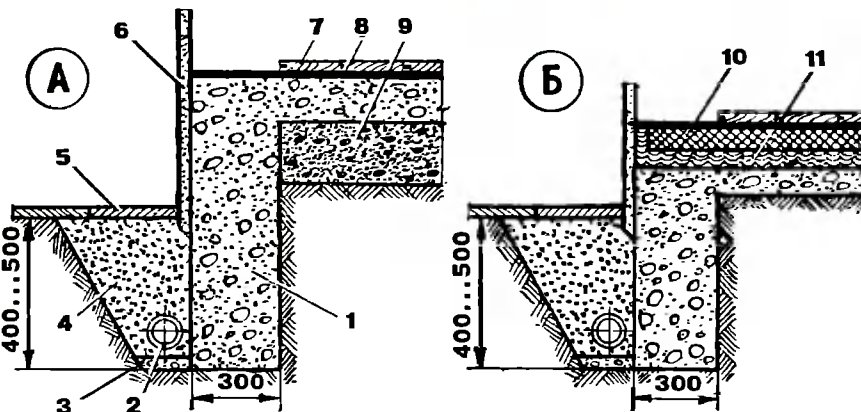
Фундамент (А — с холодным полом, Б — с утеплением):
